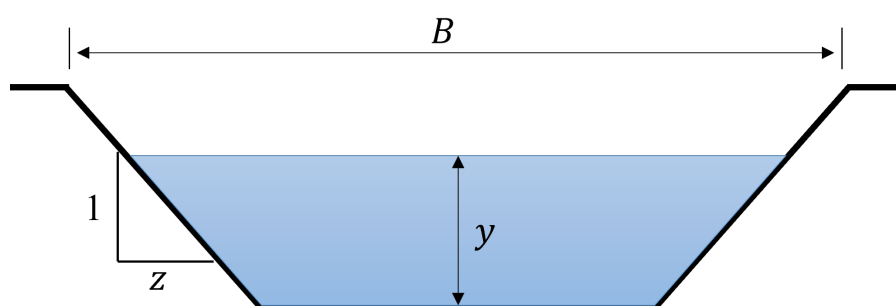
Croquis d'un seuil de section trapézoïdale.
